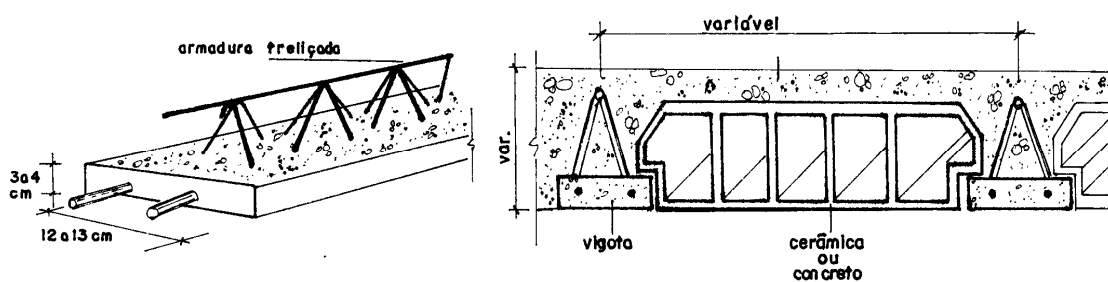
Elementos de uma laje pré-fabricada treliçada. (Fonte: Milito)
